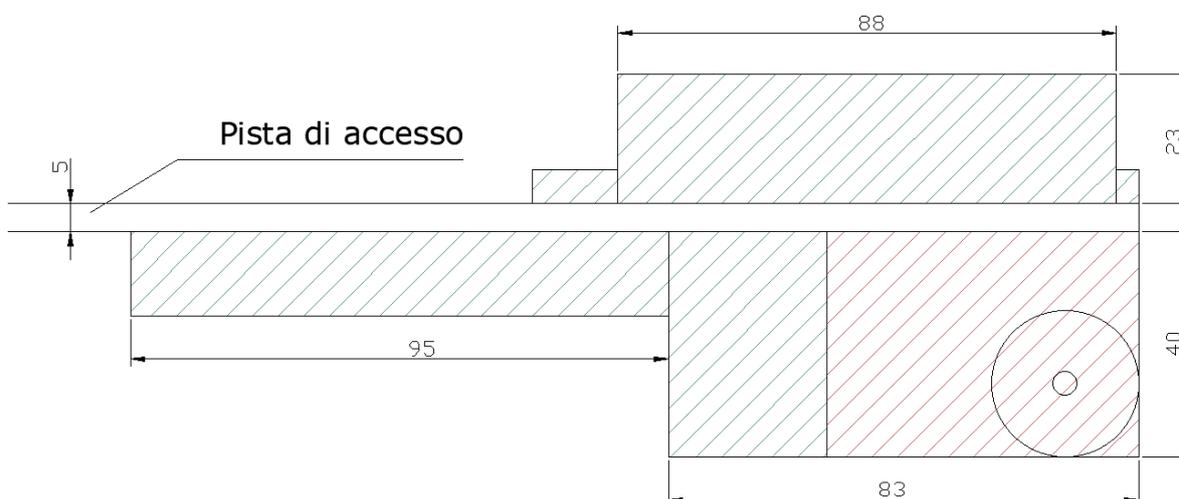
Tipico piazzola di cantiere con quote espresse in metri
